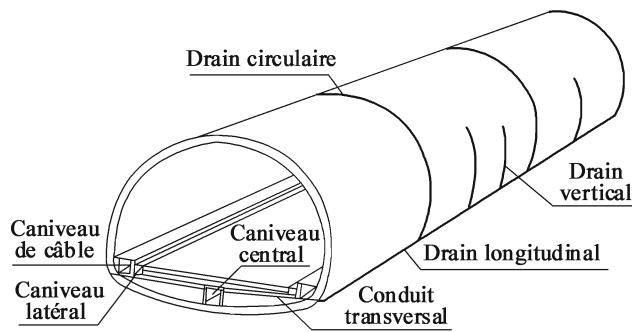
Schéma du système de drainage du revêtement de tunnel
